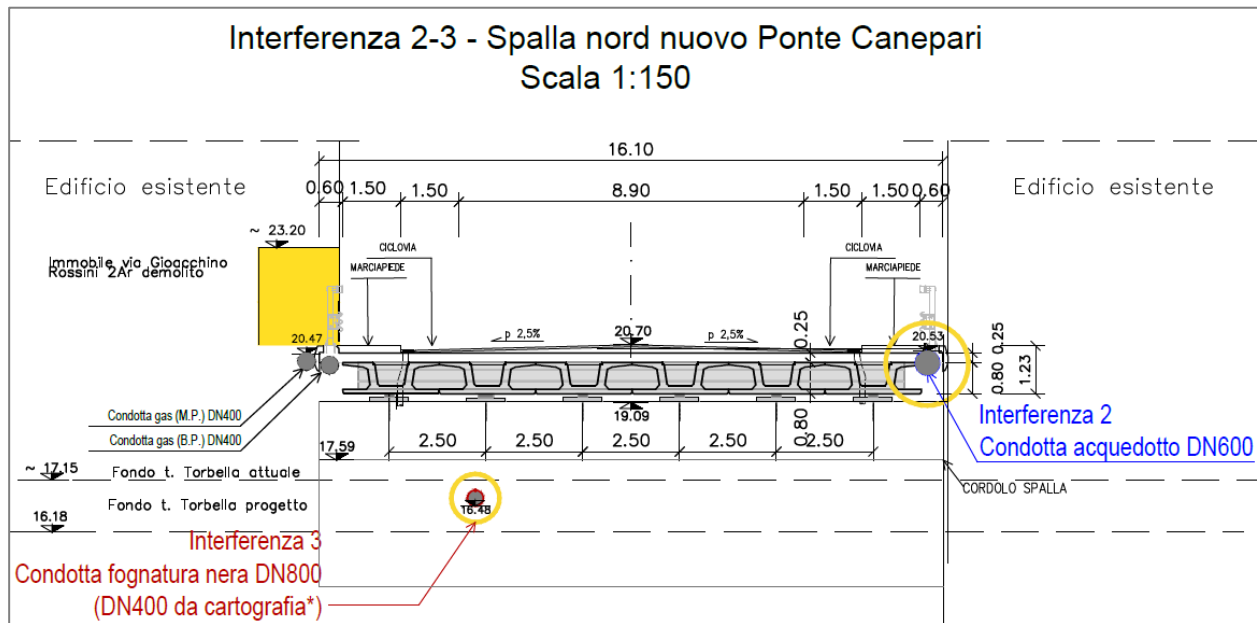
Sezione trasversale del nuovo ponte di via Canepari in corrispondenza della spalla nord (evidenza dell'interferenza 2)
